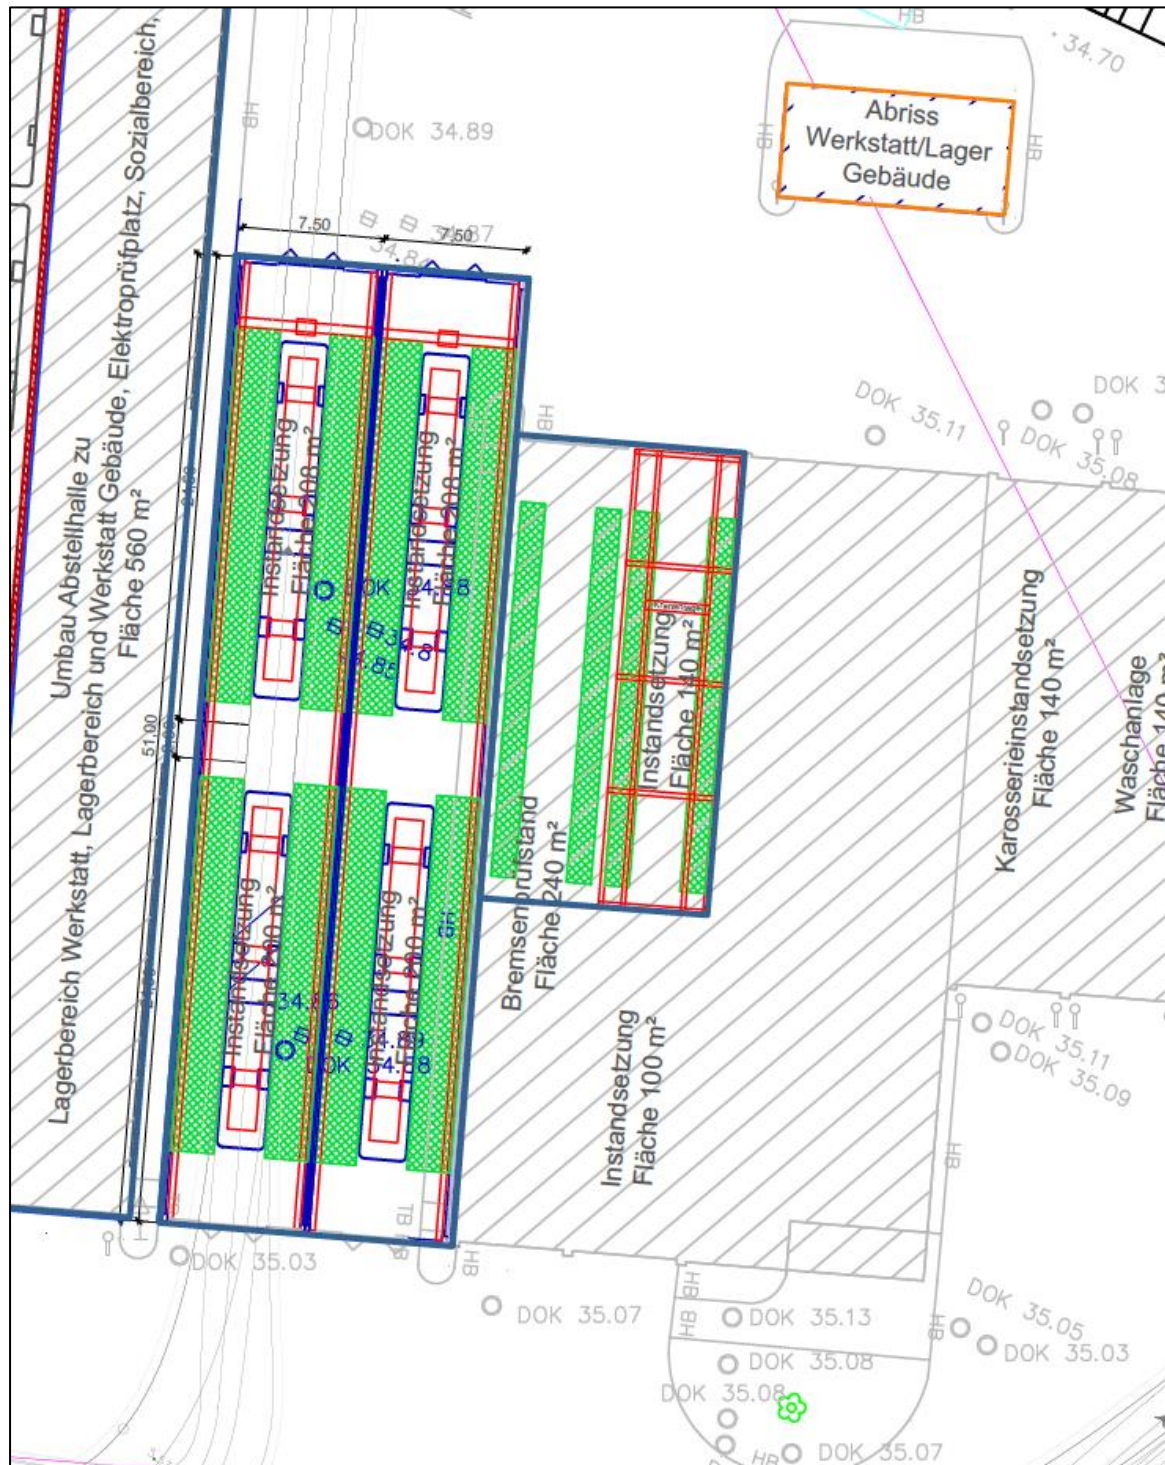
Germendorf Detailansicht Bauabschnitt 2
